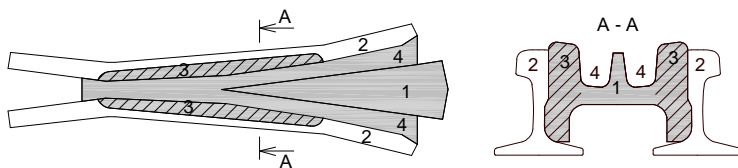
Сборная крестовина с литым сердечником типа общей отливки с изнашиваемыми частями усювиков:
